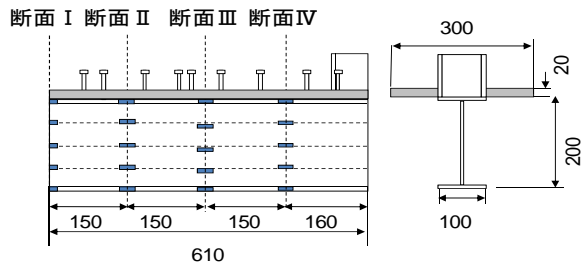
複合H形鋼供試体の形状寸法およびひずみゲージの測定位置
